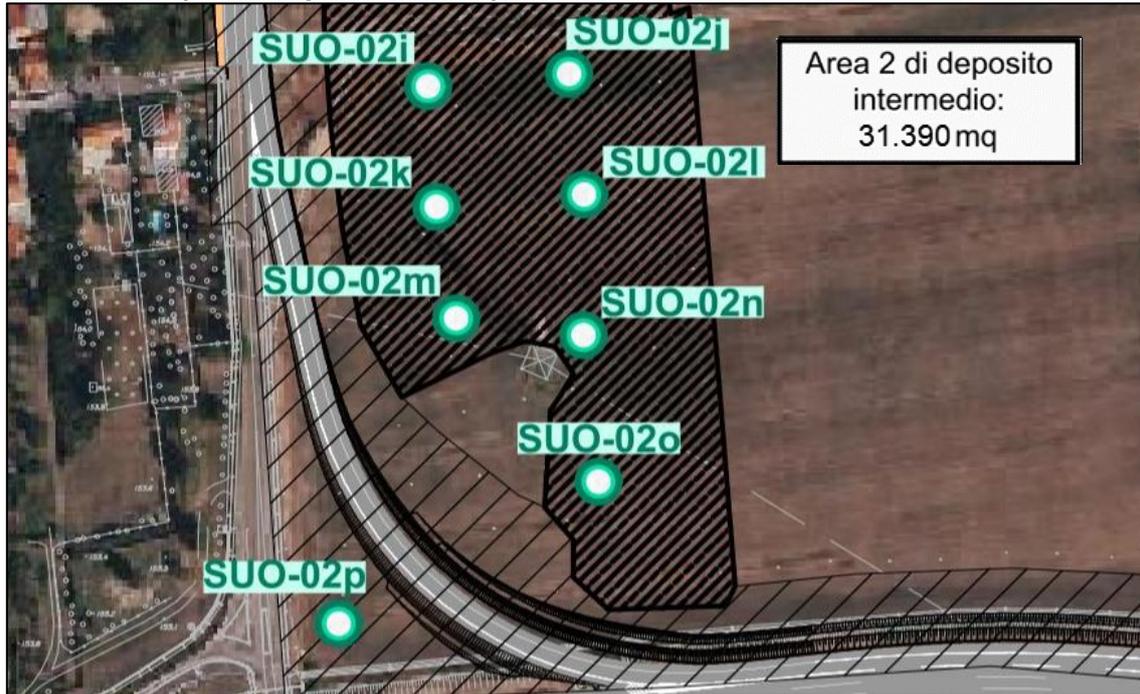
Planimetria punti di prelievo Area 2 (porzione Sud).
